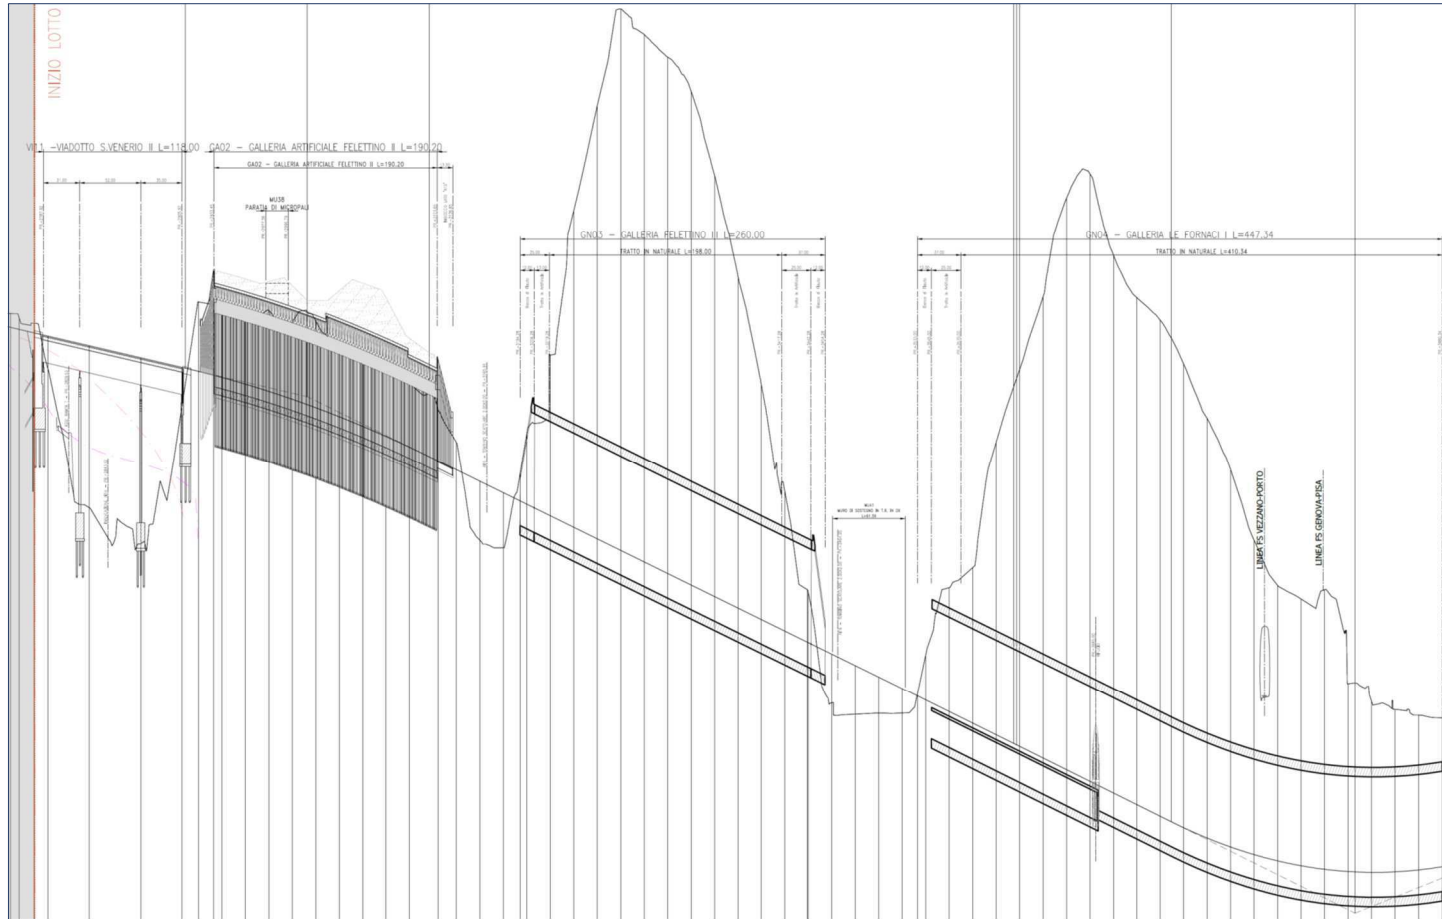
Schema planimetrico dello Stralcio “C” oggetto del progetto di completamento
